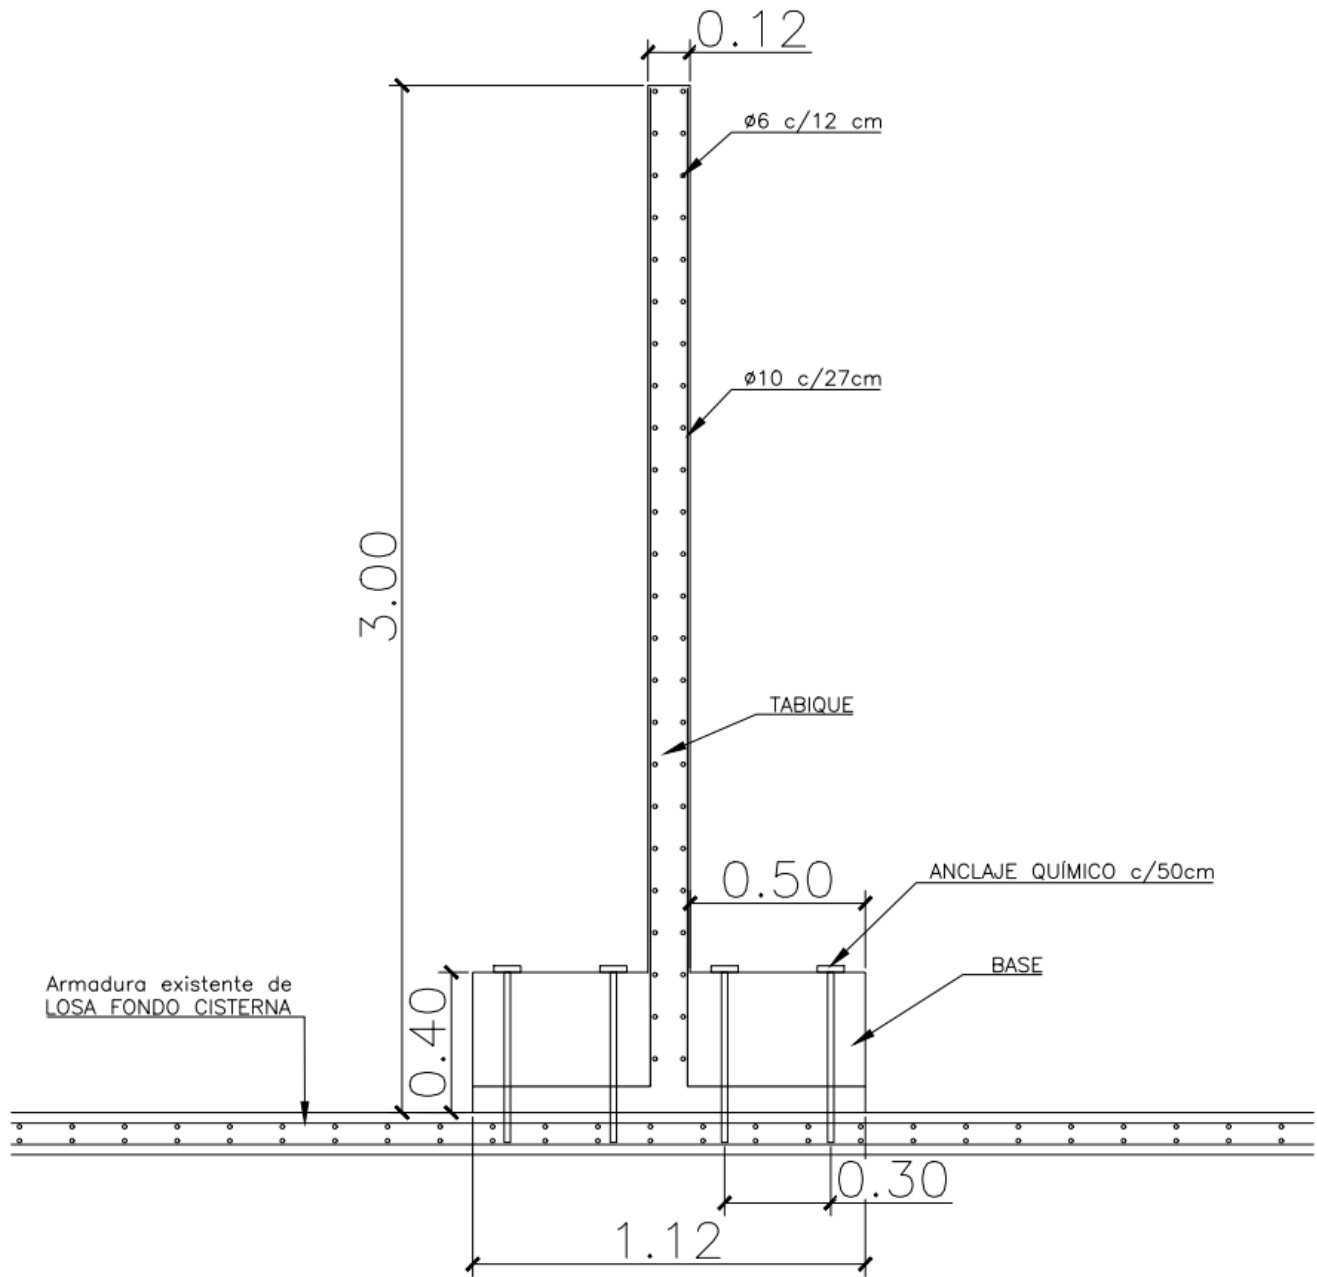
Esquema de armaduras para las pantallas deflectoras – Fuente de elaboración propia
